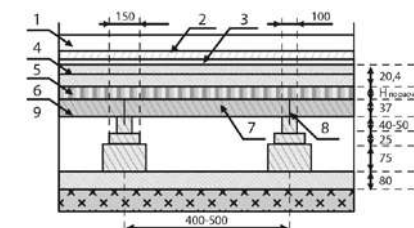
Укладка напольного покрытия на старом дощатом полу: использование ГВЛ или фанеры
